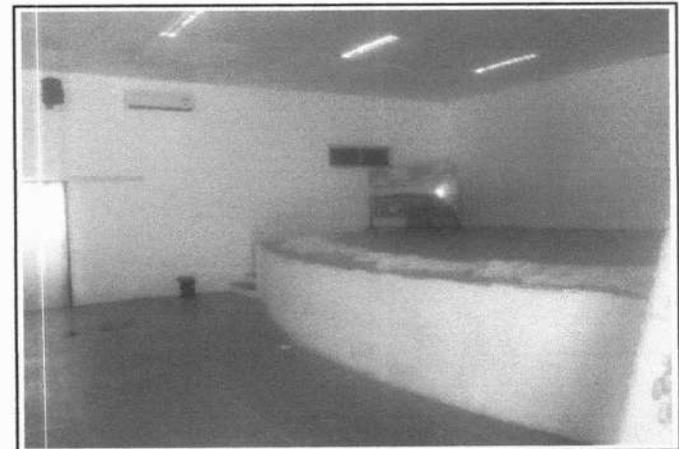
REVESTIMENTO CERÂMICO PALCO
